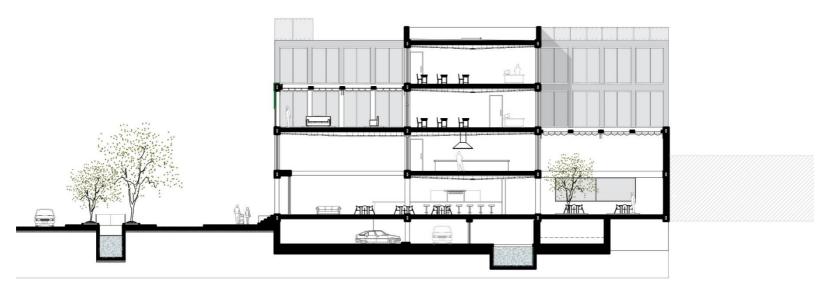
Corte transversal 3 Fuente: elaboración propia
